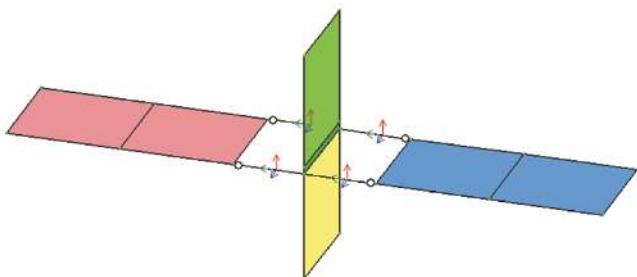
Конечно-элементная модель контактного стыка стен с опиранием плит перекрытий на консоли
